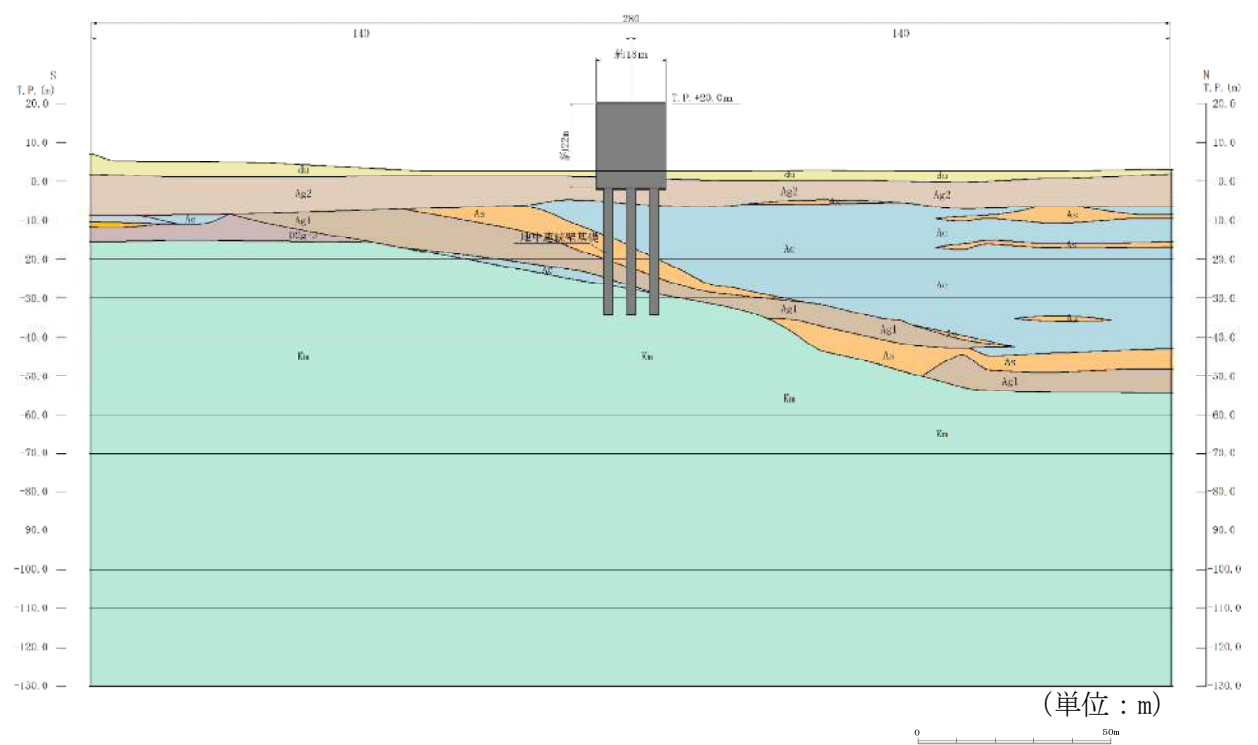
(3) 鉄筋コンクリート防潮壁 断面図(C-C断面)
